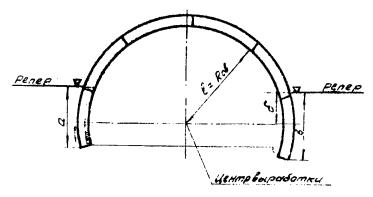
Кондуктор для установки первой арки тюбинговой крепи
